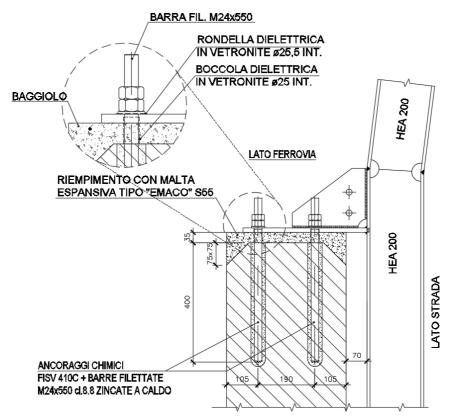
Dettaglio del collegamento superiore HEA200 barriera lato ferrovia
